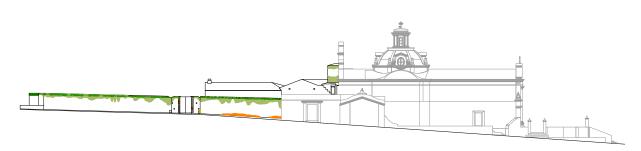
Relevamiento de lesiones - Fachada Sur
